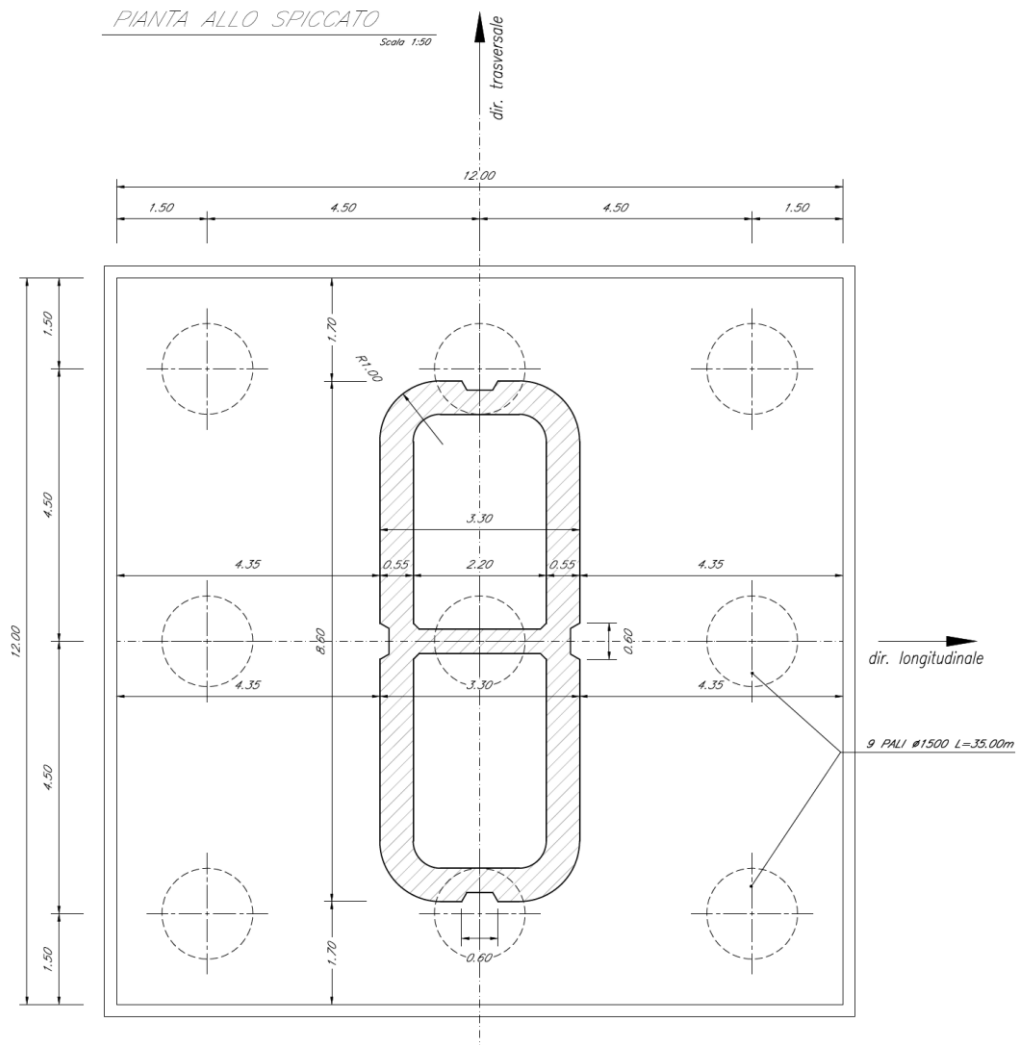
Plinto di fondazione e pali, vista in pianta - Sezione del fusto pila [m]
